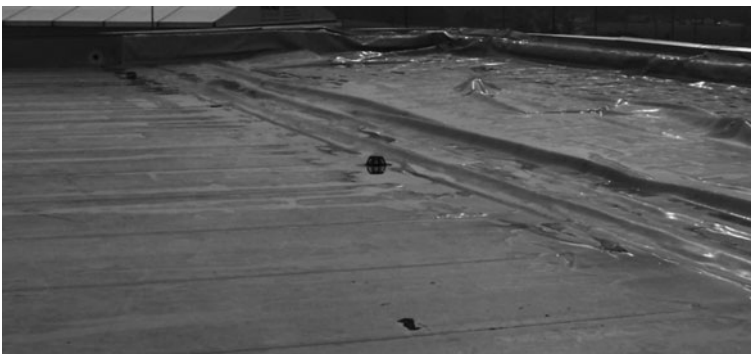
Im linken Bildbereich wurde der Dachaufbau mechanisch befestigt und blieb unbeschädigt, während die Abdichtung im Bereich der Verklebung weggerissen worden war (rechts).
